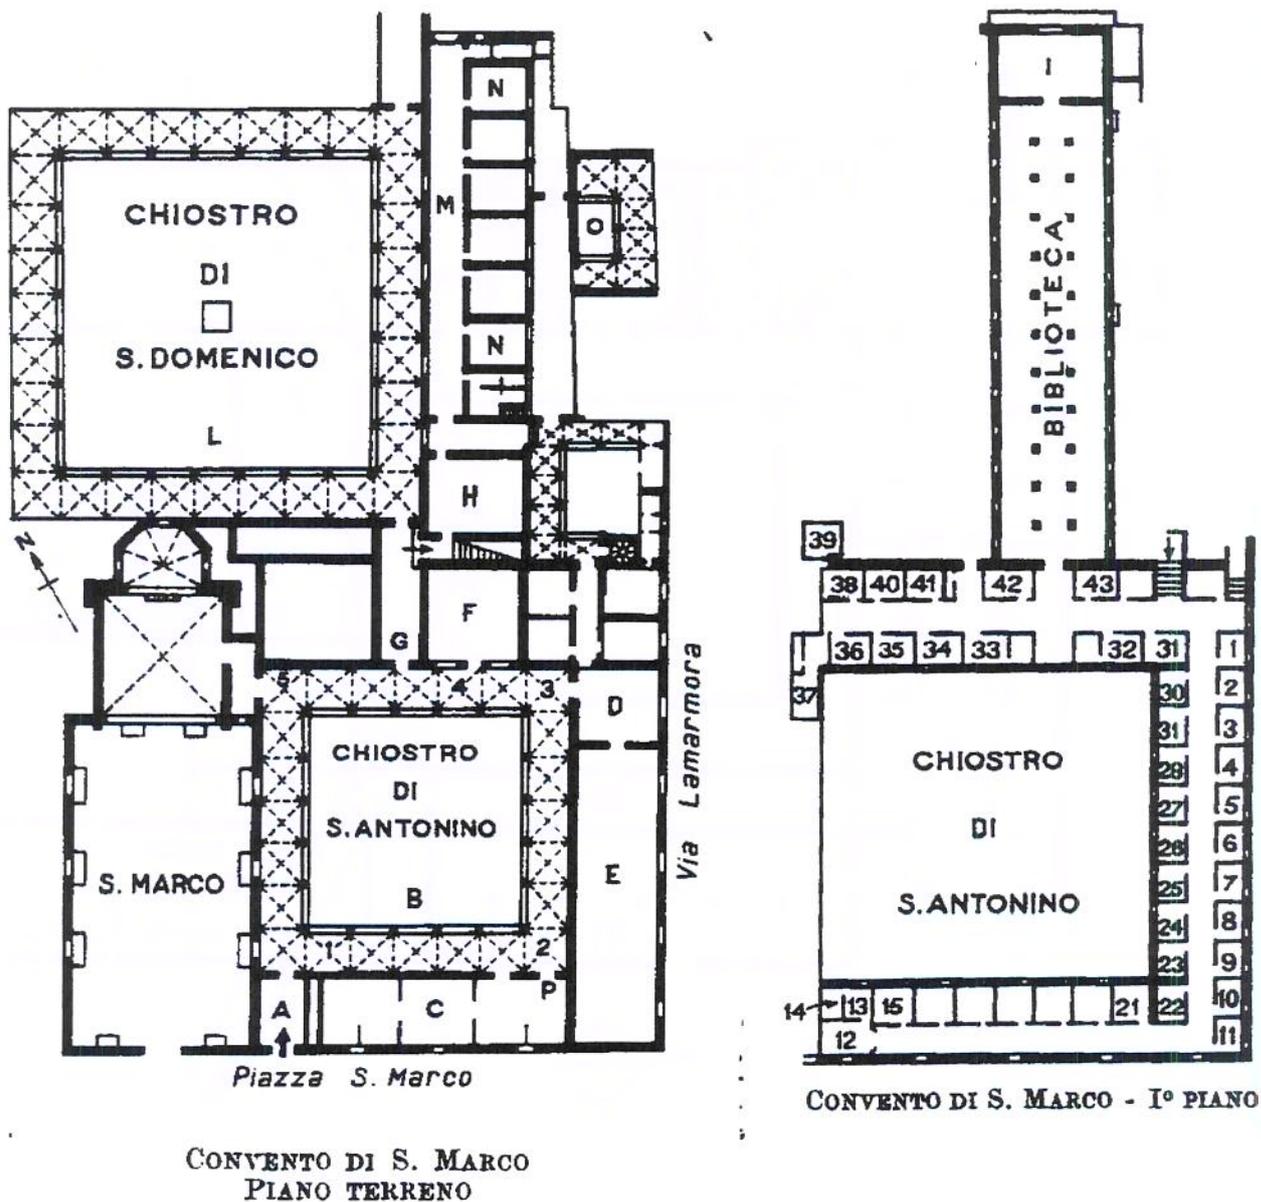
Florença, Itália. Convento de San Marco. Plantas térreo e primeiro pavimento
